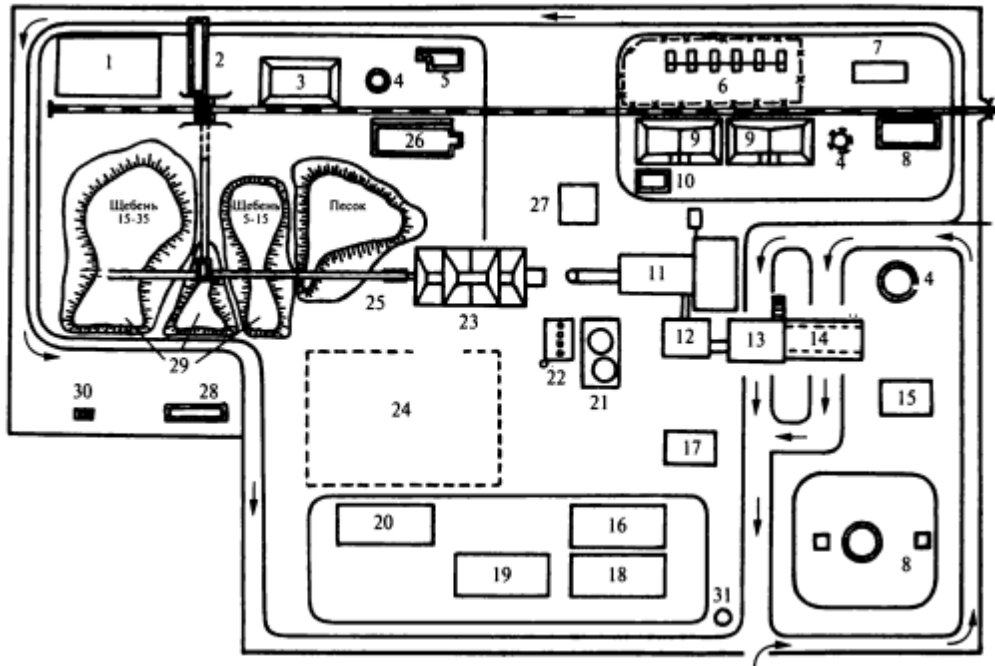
Генеральный план асфальтобетонного завода:
